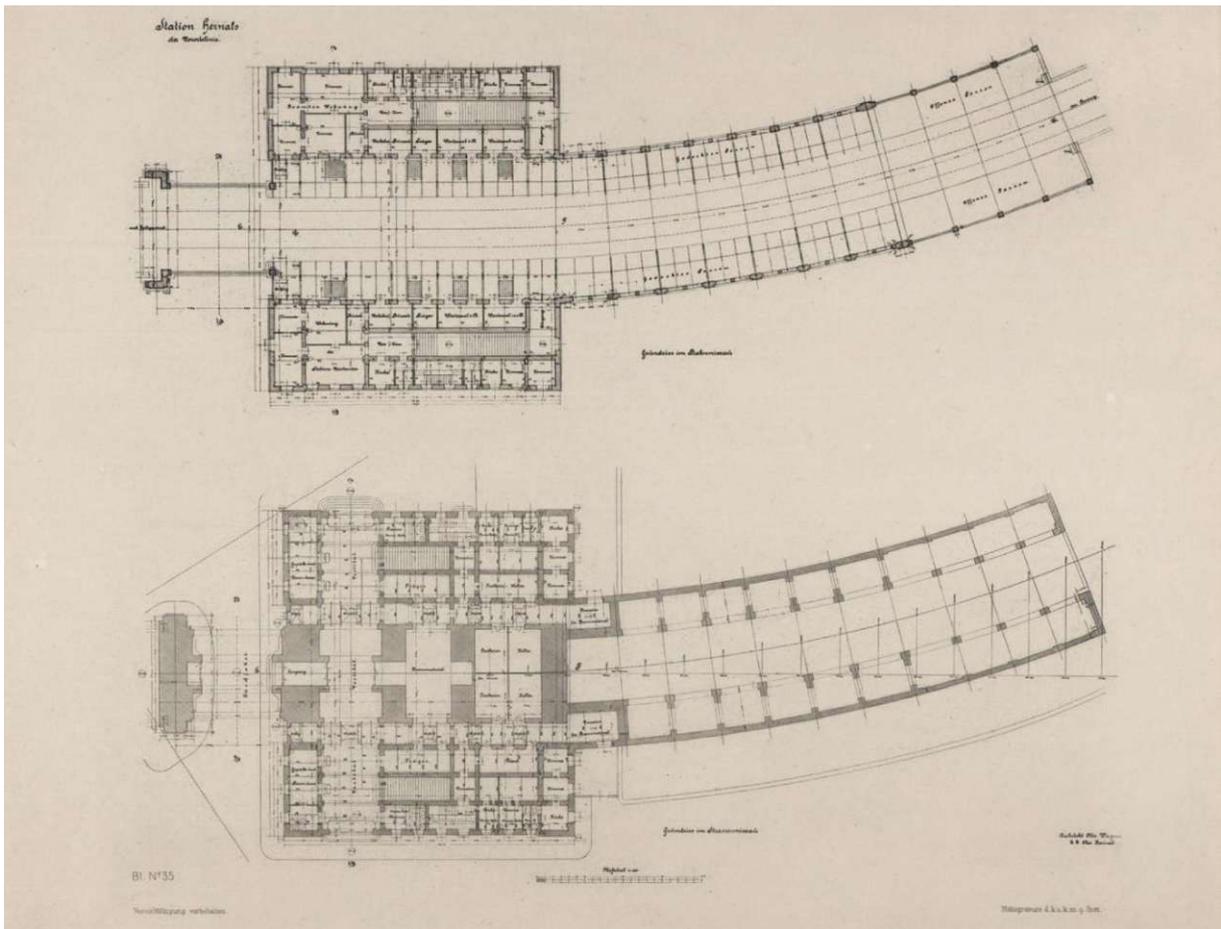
Grundrisse Bahnhof Hernalers
